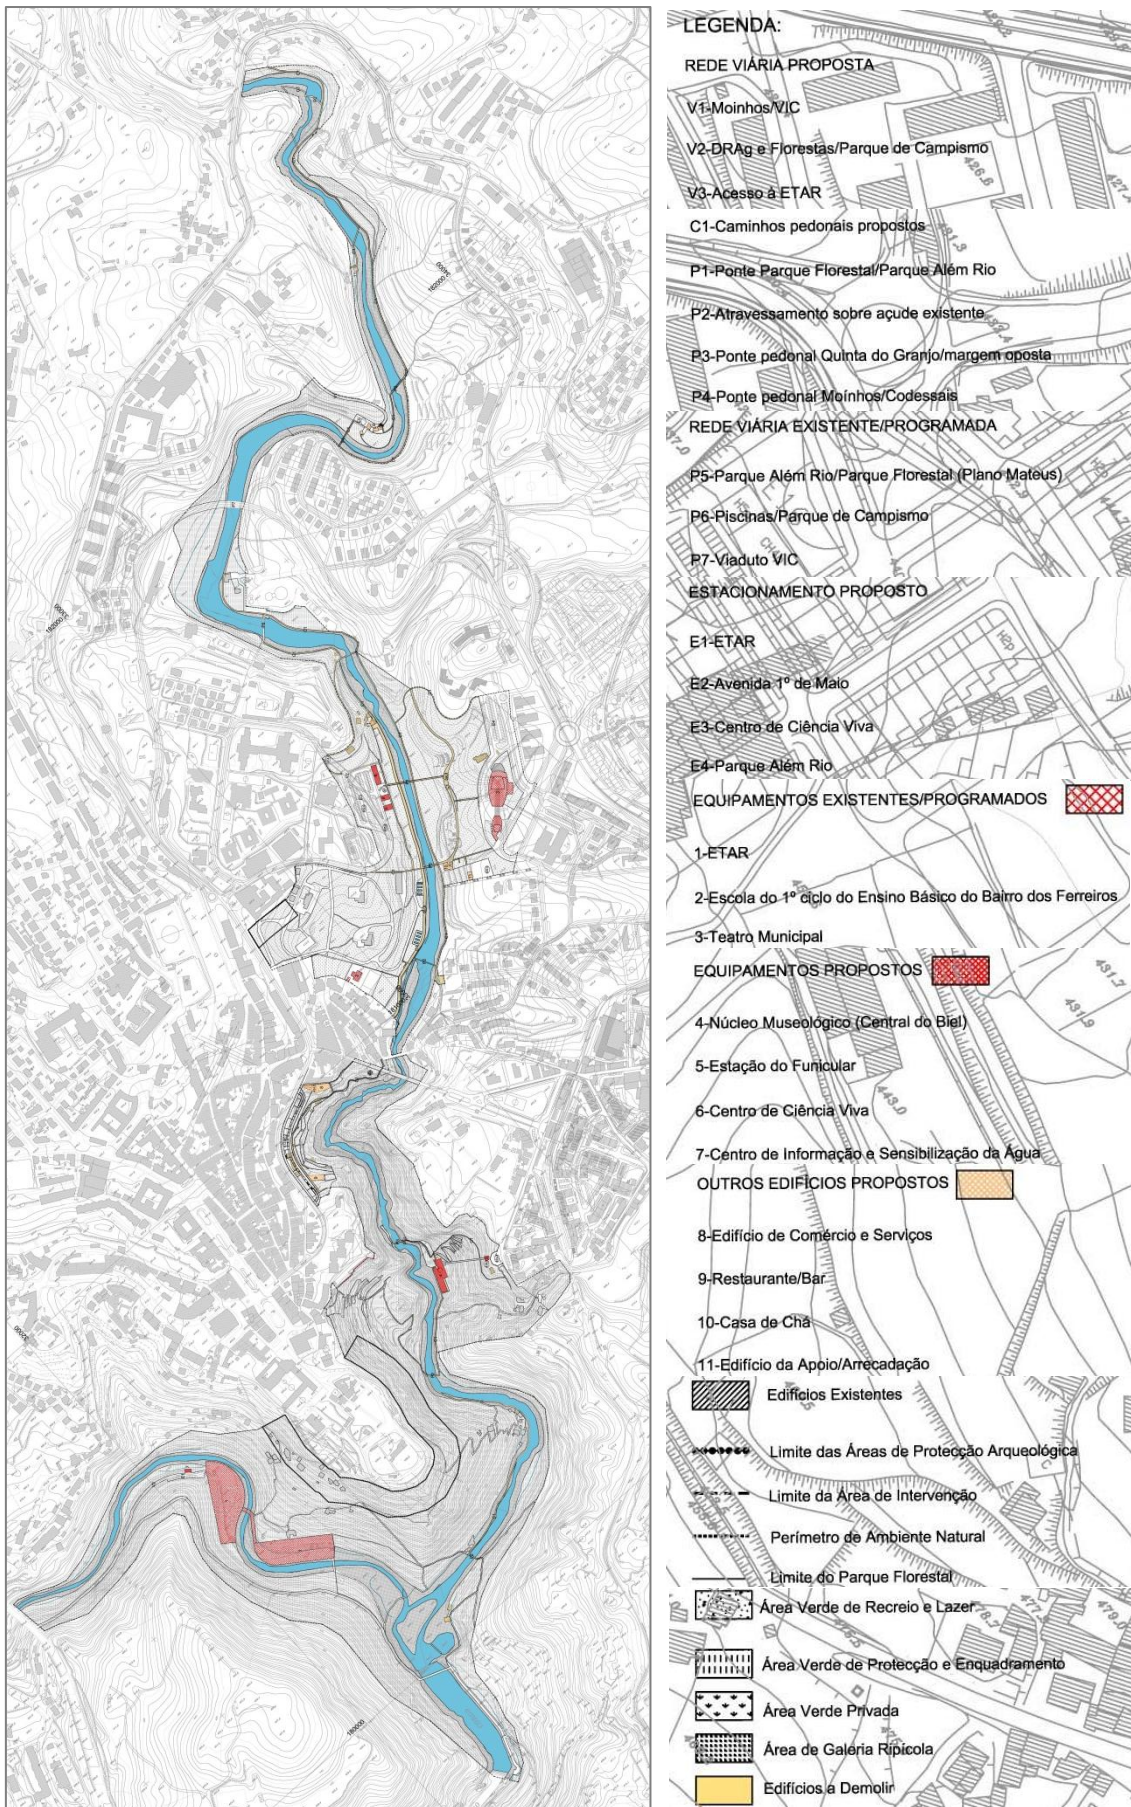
Extracto da Planta de Implantação do PPPC e Legenda (2003)
